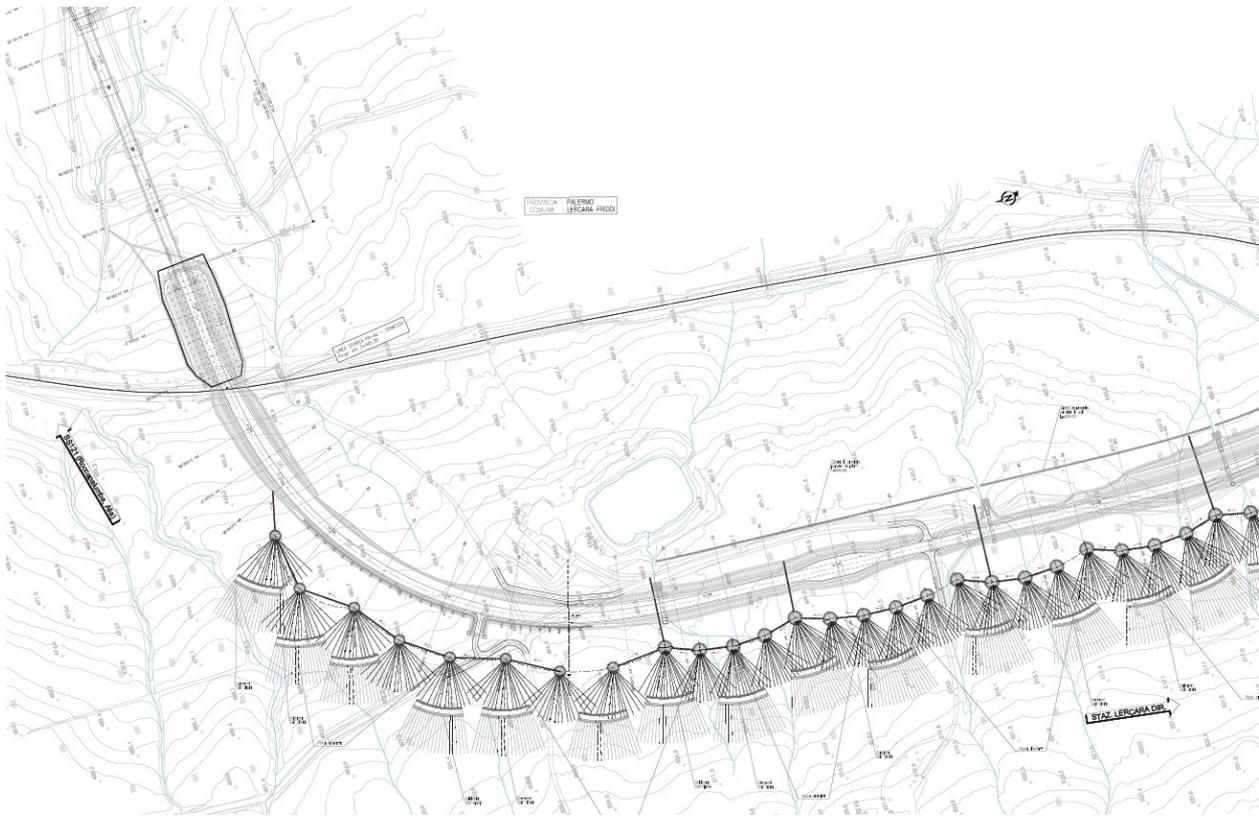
Planimetria di progetto dalla Km 0+750 alla Km 1+535
